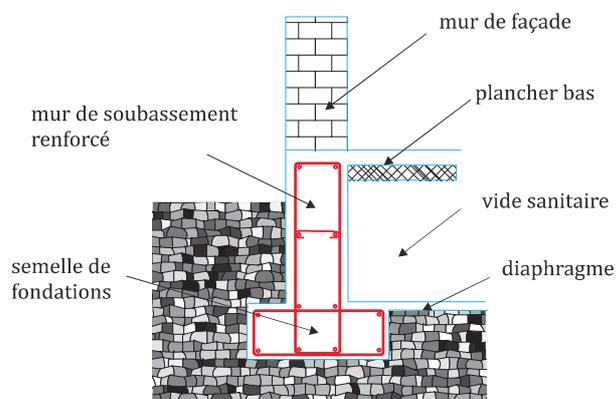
Principe de fondation avec mur de soubassement renforcé
